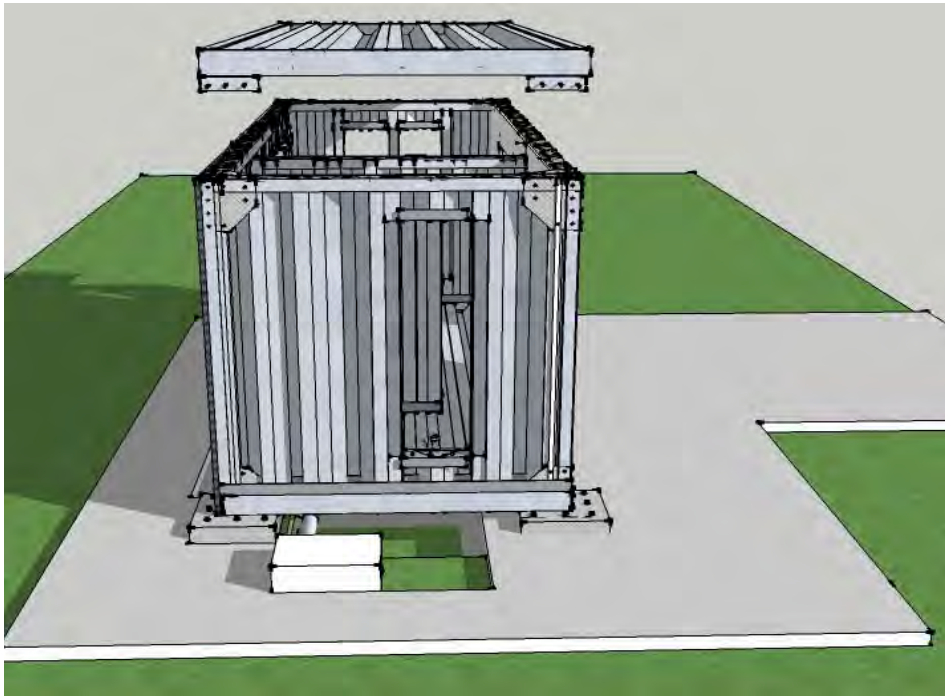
Deconstrucción del Módulo. Fuente: Elaboración propia. 2012
